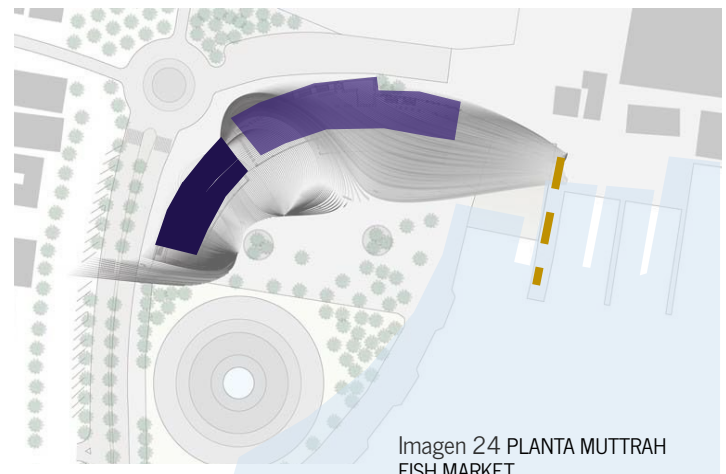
PLANTA MUTTRAH FISH MARKET
